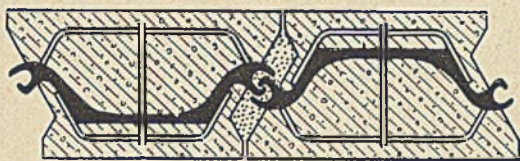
Betonumkleidete Eisenspundwand mit Bügelbewehrung und nachträglichem Verguß der Nuten.
